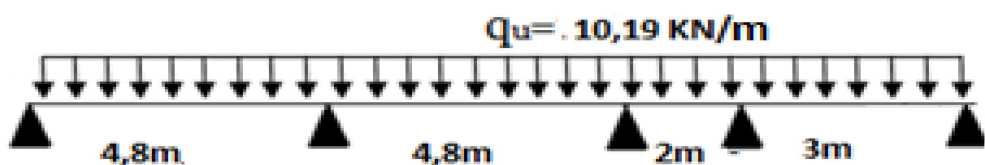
Schéma statique d'une poutrelle type1 à l'ELU.
